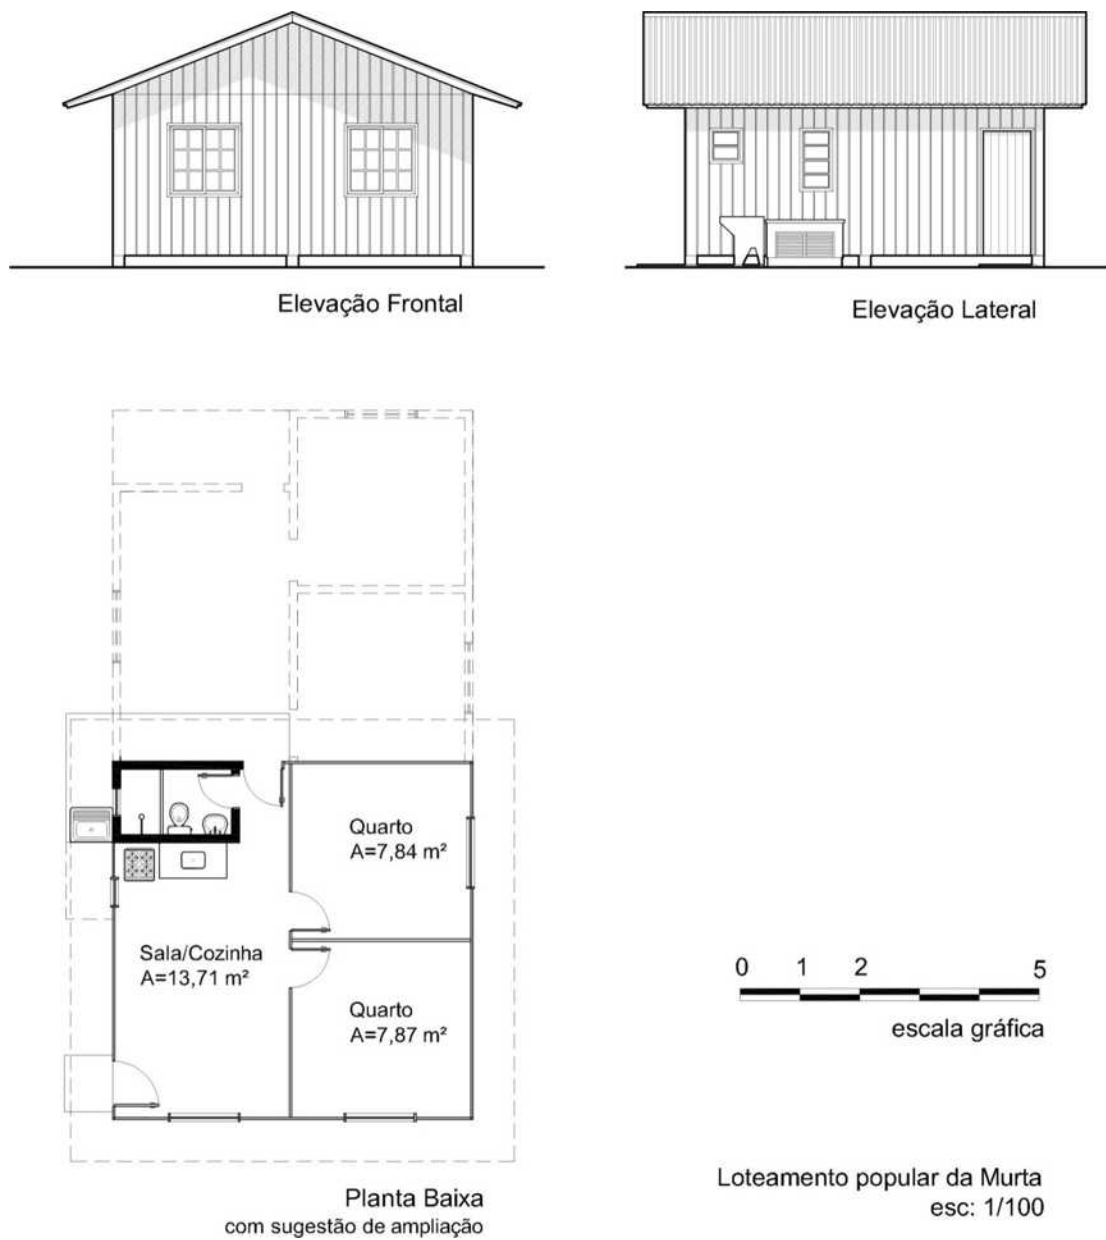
Desenho técnico da casa do conjunto com sugestão de ampliação.
